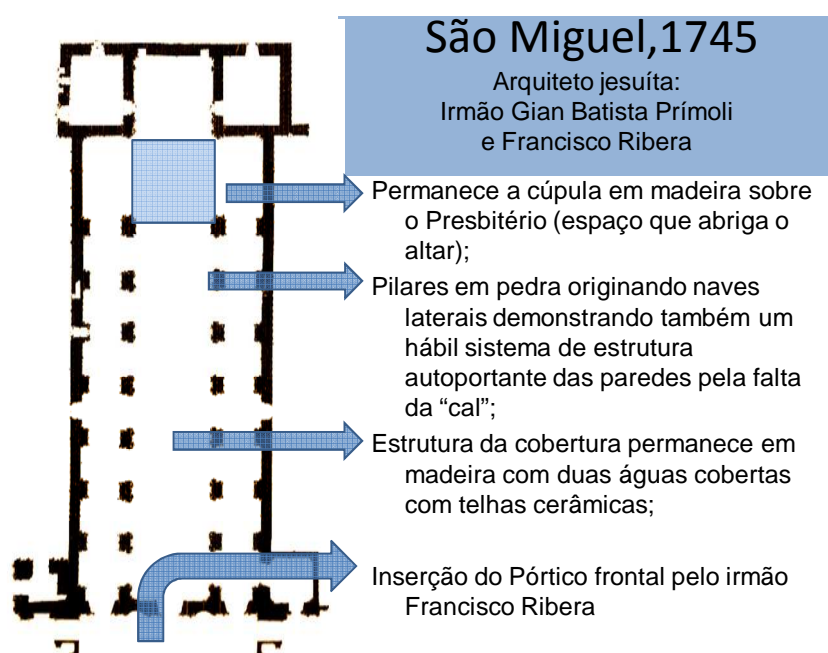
4ª Etapa: Planta da igreja de São Miguel, 1745
